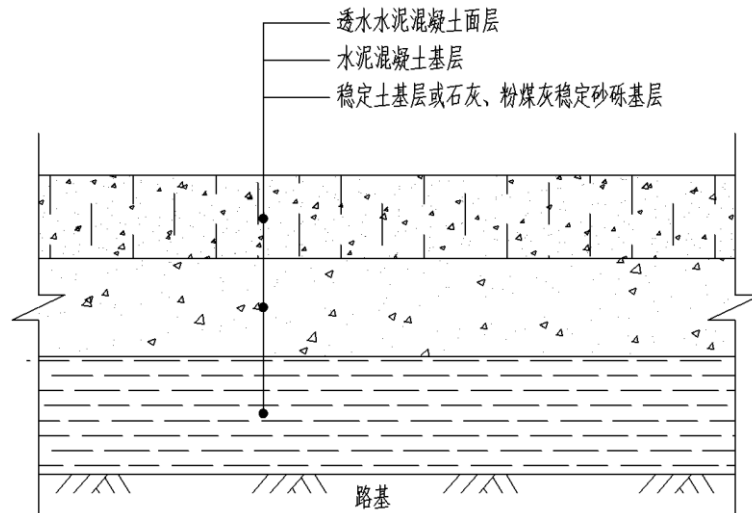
半透式透水水泥混凝土路面结构示意图
